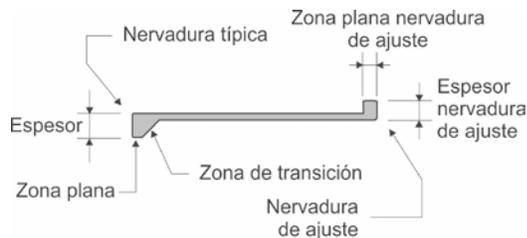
Sección transversal del PV tipo ajuste Zona plana nervadura
